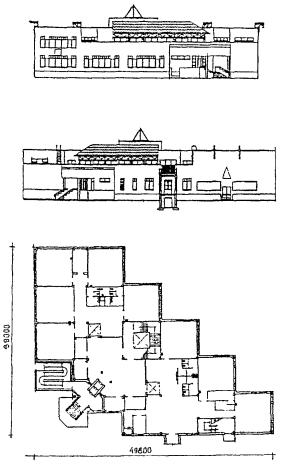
Проект блока-пристройки на 8 начальных классов 200 учащихся И-1745/2А (разработан в 1998 году). Фасады и план первого этажа.
